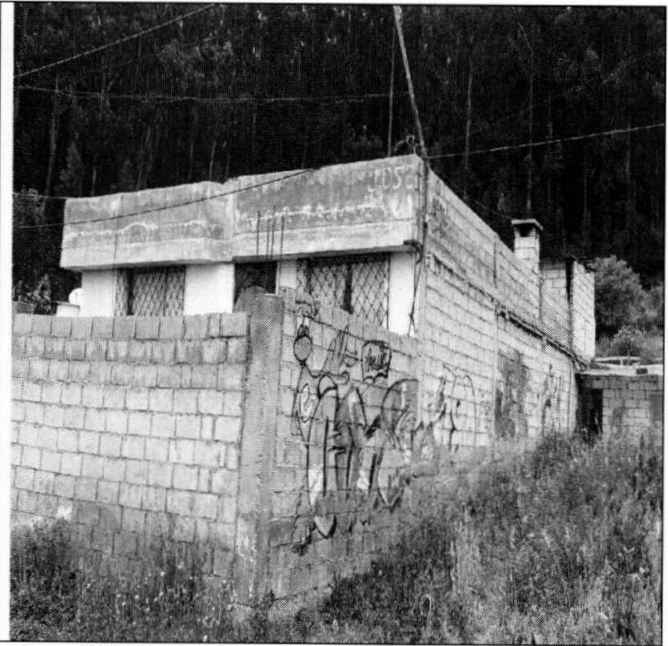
Vista Exterior / Construcción N° 5 / Habitada
